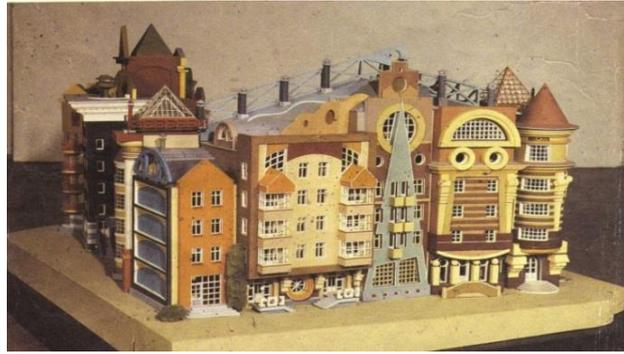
Цветовое решение фасадов зданий с простой и сложной пластикой
